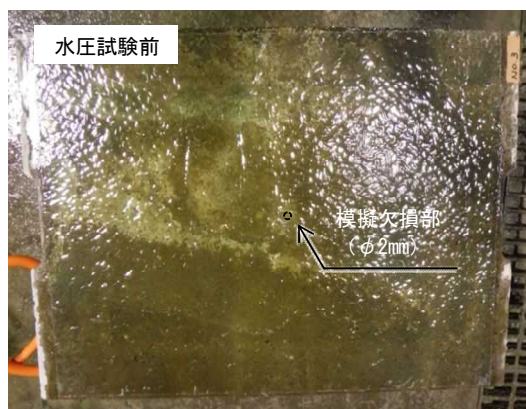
試験 No. 1 開口寸法 直径φ2mm
